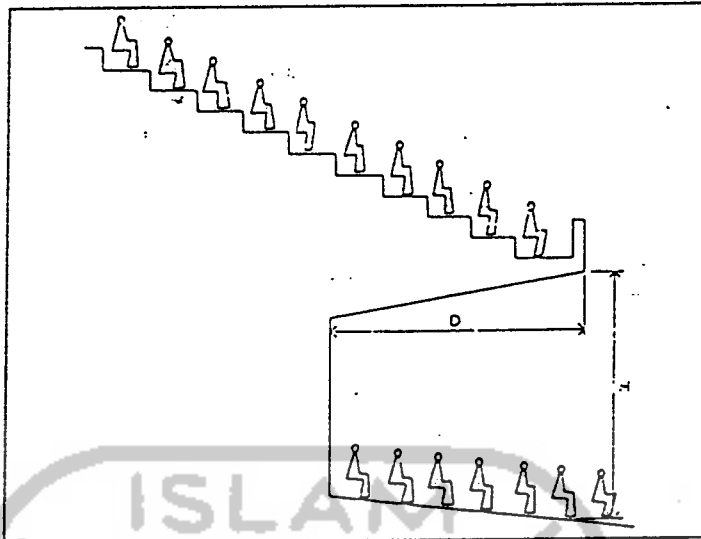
Bentuk-bentuk lantai ruang konser (Sumber : D. Mills, 1976)
